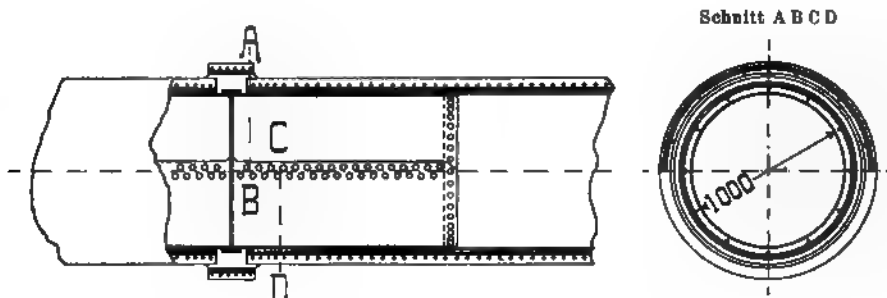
Betonröhren mit Stahlgerippe, System Bonna.
